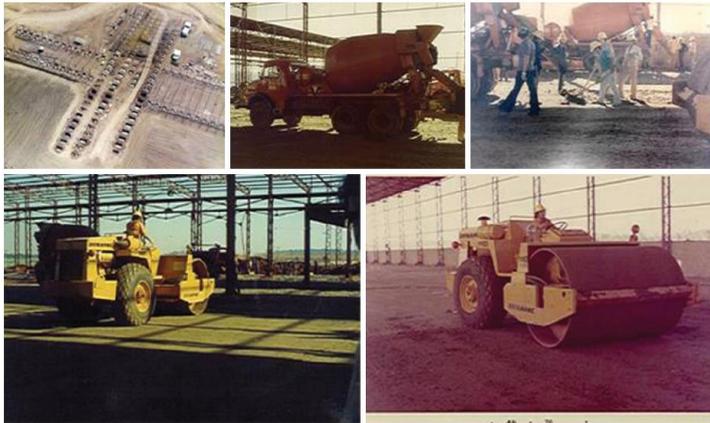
Aplicação do Concreto Compactado com Rolo no Pavimento dos Almoxarifados do Construtor [08]
